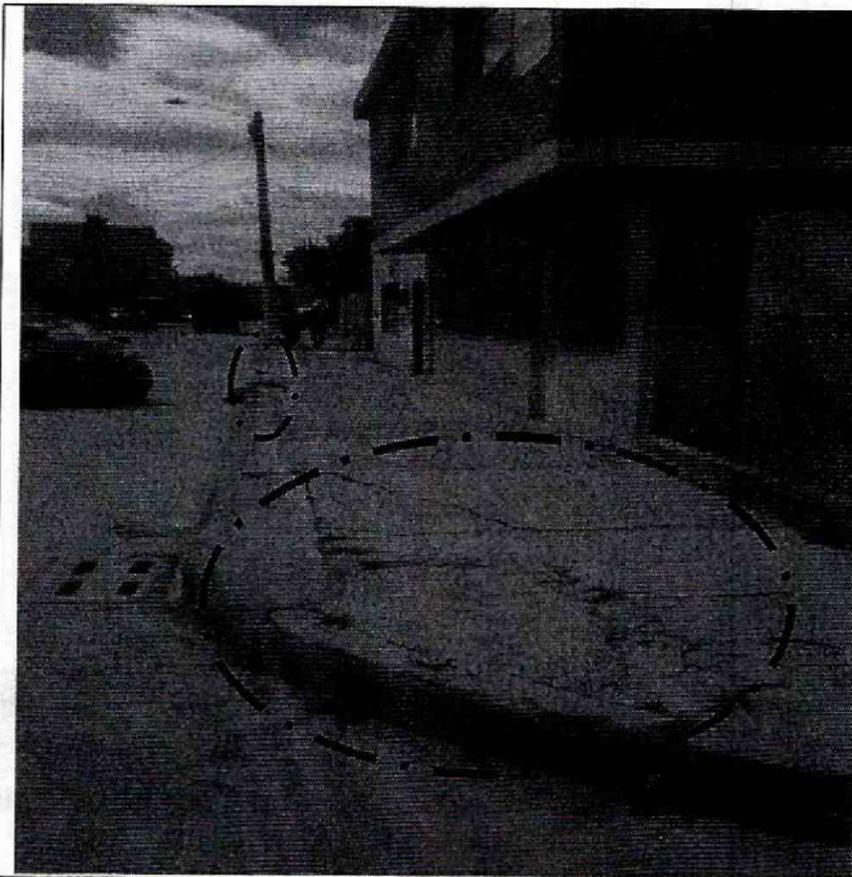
Fisuras y fracturas identificadas en andén peatonal en el sector comprendido entre la intersección de la Calle 137 A y La Carrera 98 B
